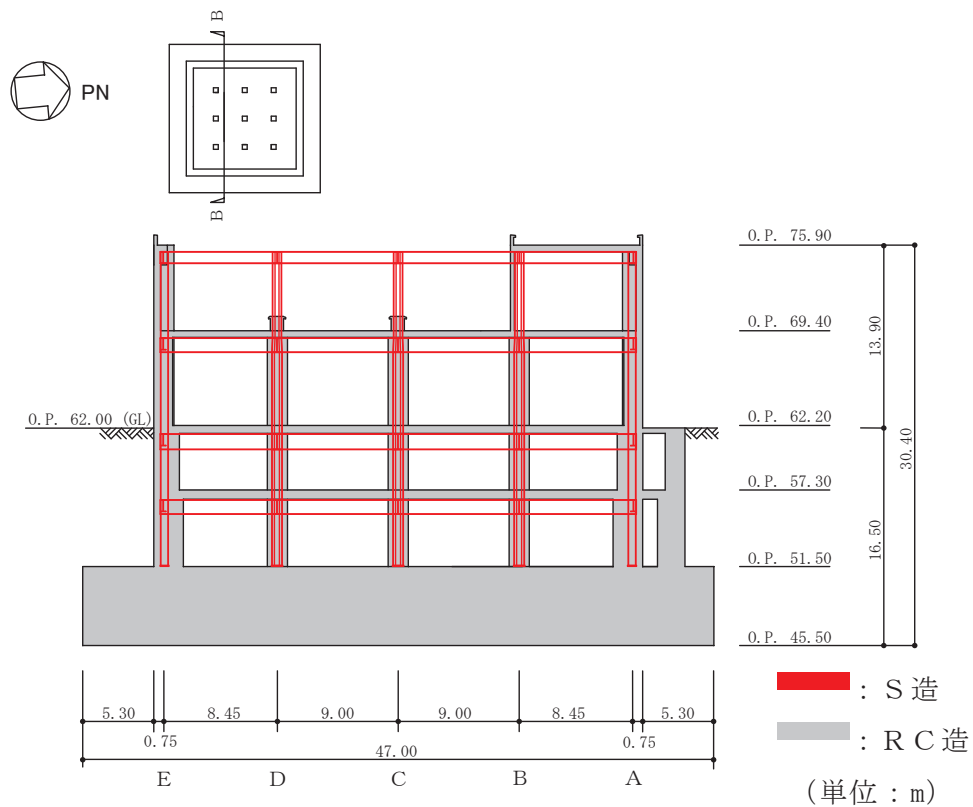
(2) 緊急時対策建屋の概略断面図 (B-B 断面, EW 方向)
